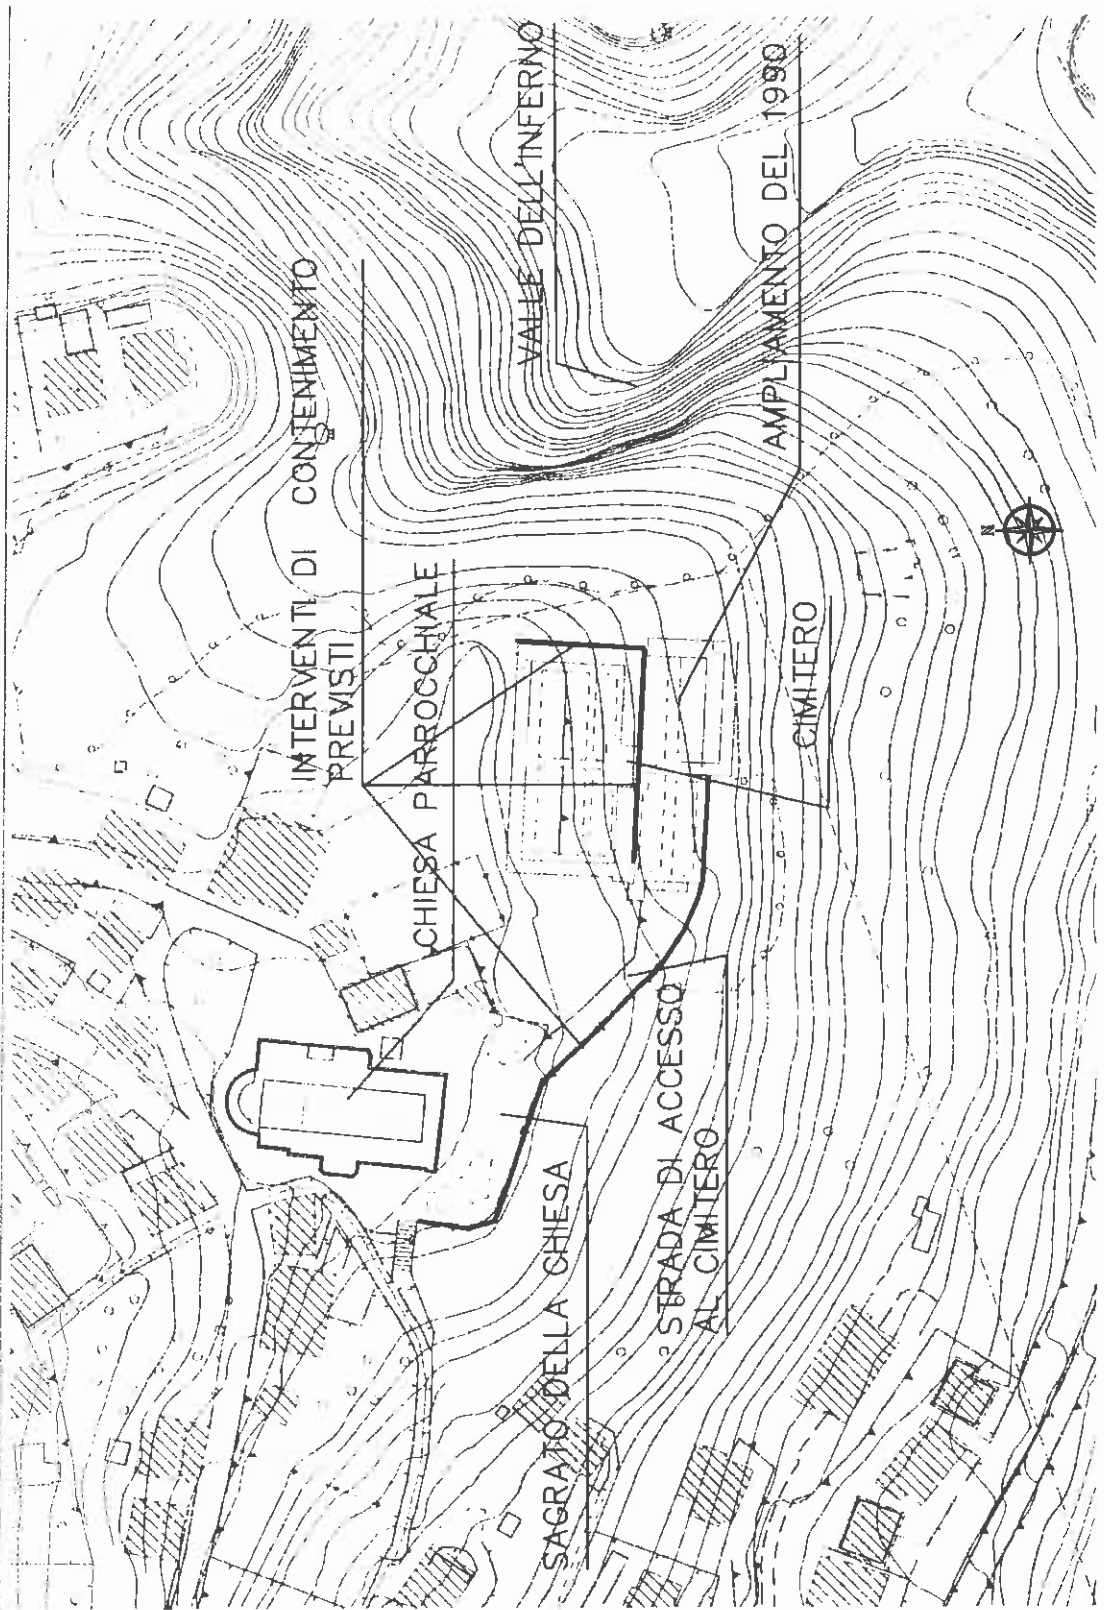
Planimetria dell'area con indicazione dell'ubicazione delle opere di contenimento previste
